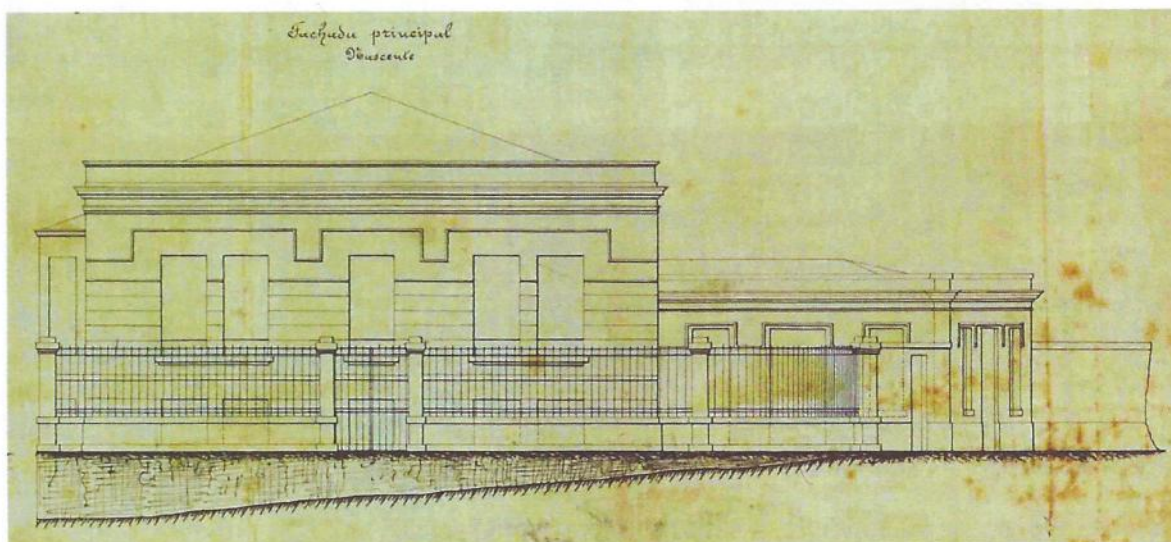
Alçado principal da Casa do arquiteto Domingos Parente da Silva (AICML, processo de obra 38338).
